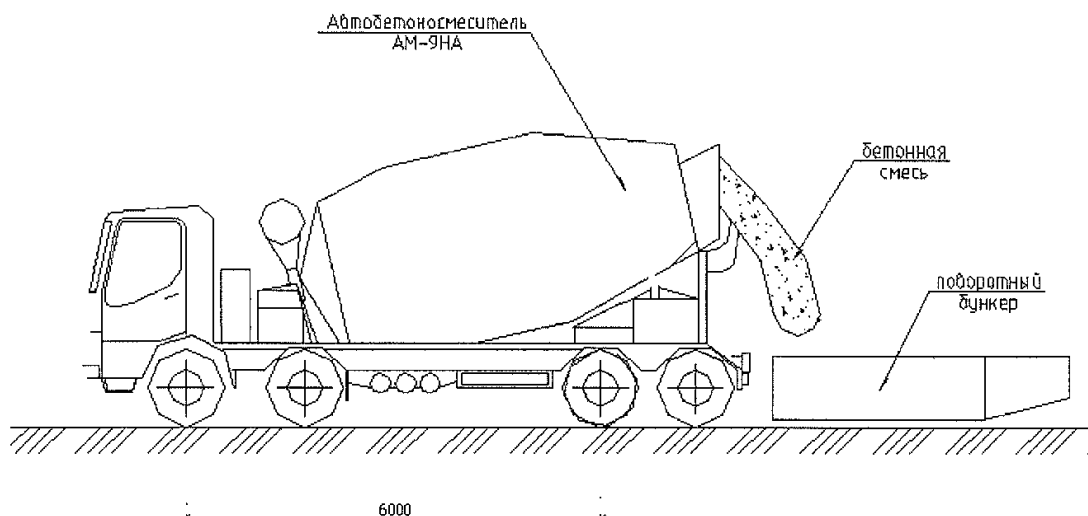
Выгрузка бетонной смеси из кузова автобетоносмесителя.
